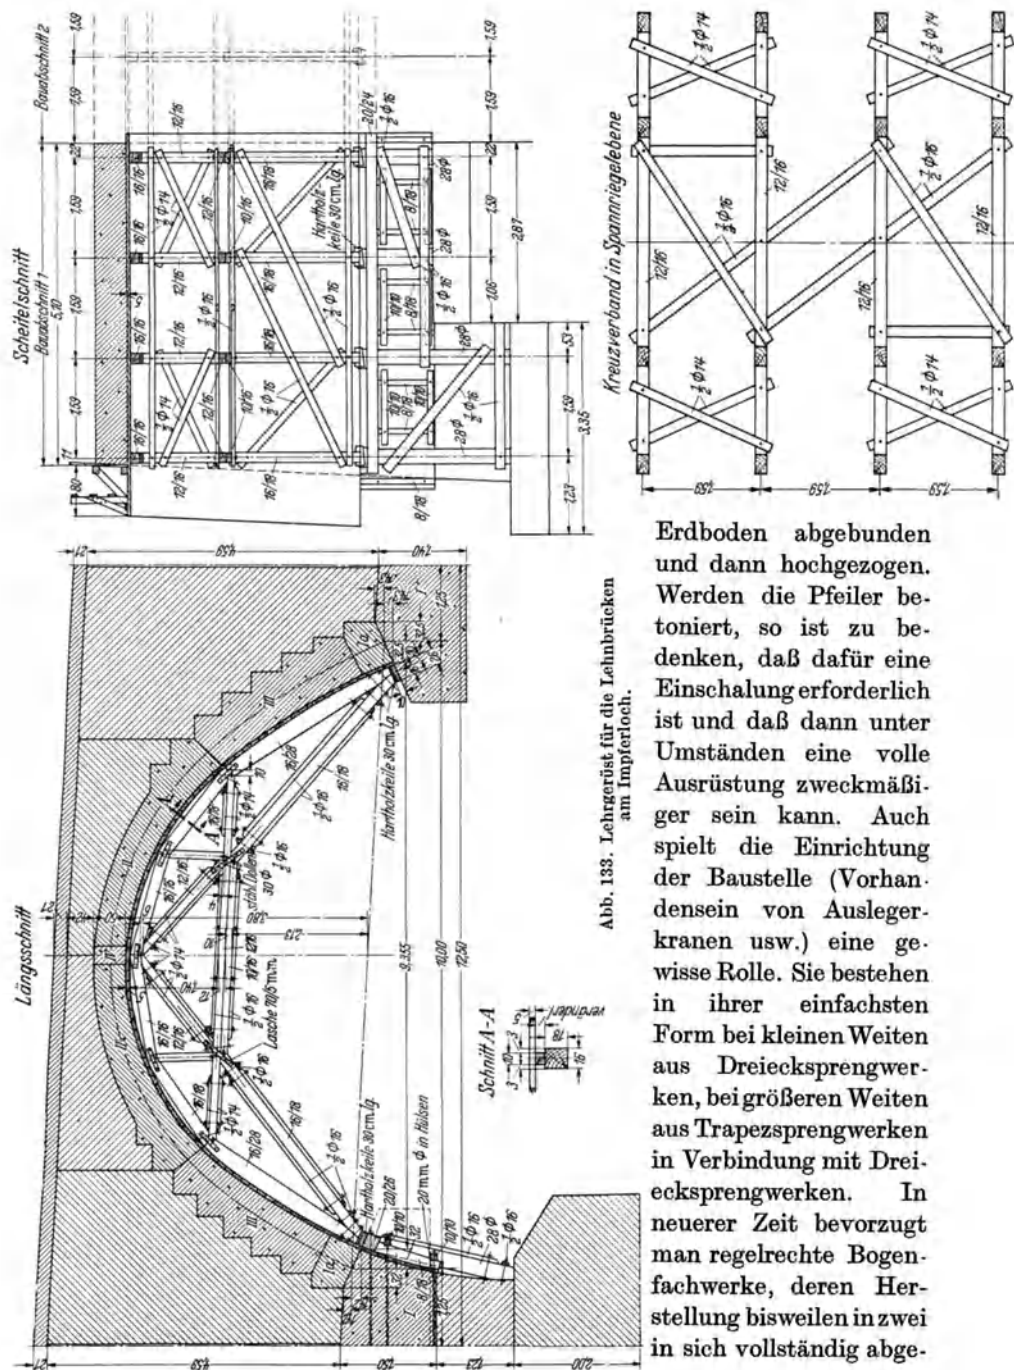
Lehrgerüst für die Lehnbrücken am Impertloch.
